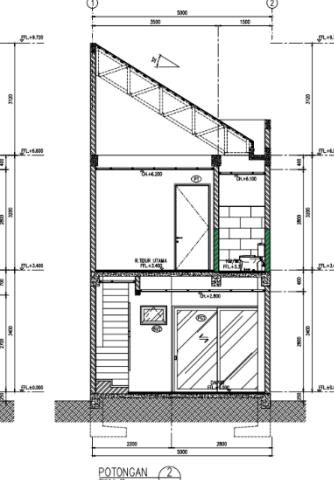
Tampak Tipe Bangunan 5x14 Standard
